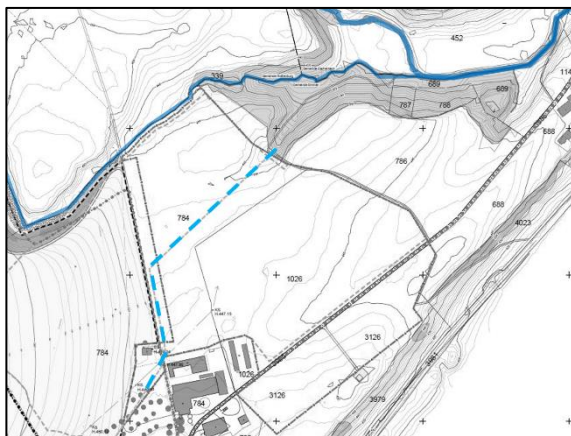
Ausschnitt aus dem Plan P-1, Ausgangslage (26.10.2020) mit Rütibächli/Waldibach im Norden und bestehender, bewilligter Hauptentwässerungsachse (hellblau gestrichelt).
